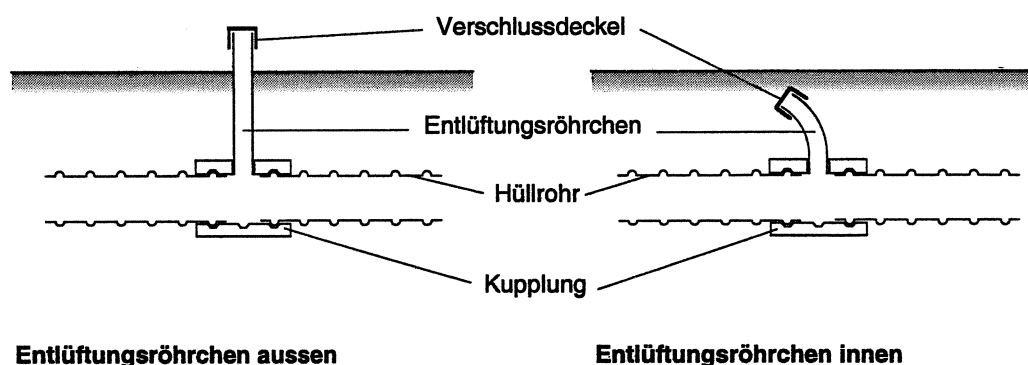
Betonprobekörper mit Entlüftungsröhrchen
